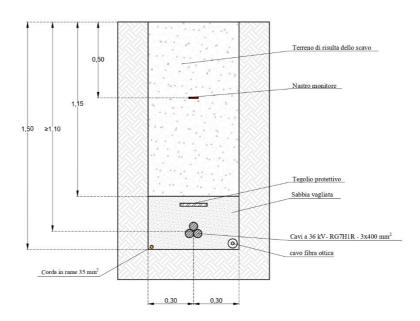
dettaglio di sezione cavidotti AT esterno ed interno
